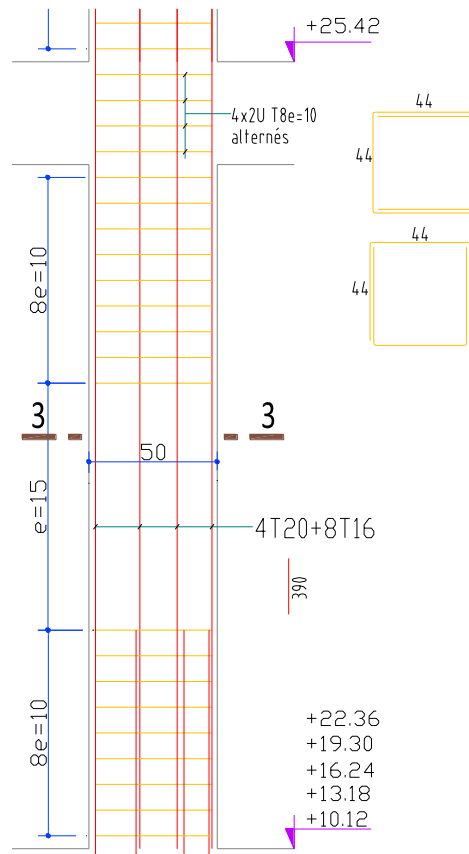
Coupe verticale de ferrailage de des poteaux $50 \times 50 \text{ cm}^2$.
